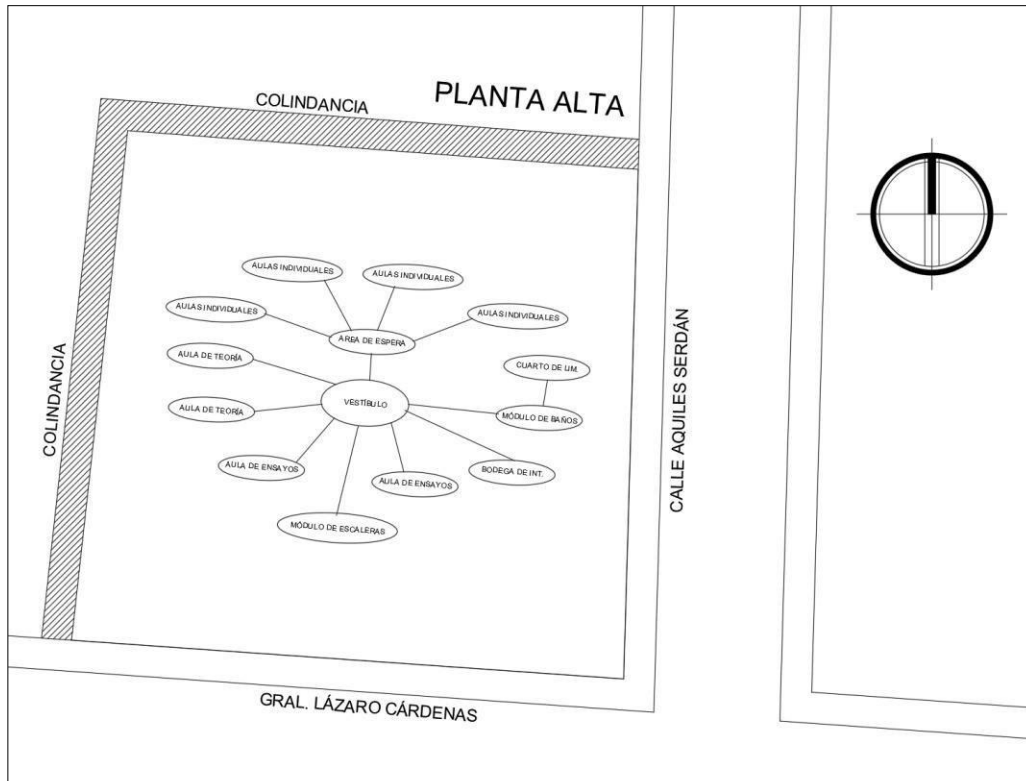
Segunda Propuesta, Planta Alta. Propia 2021.
